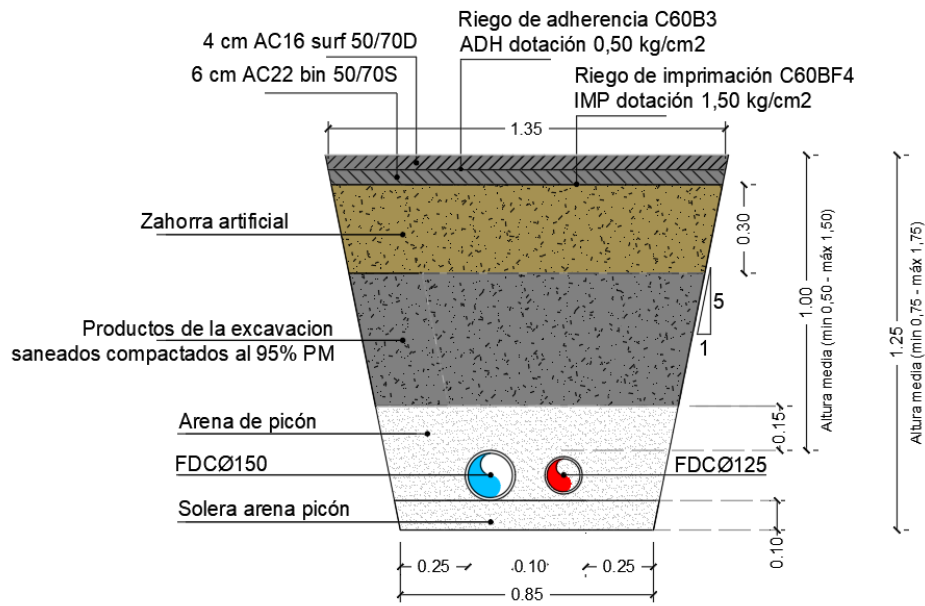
Figura VII. Sección tipo en tramo de calzada. Aducción y distribución.
